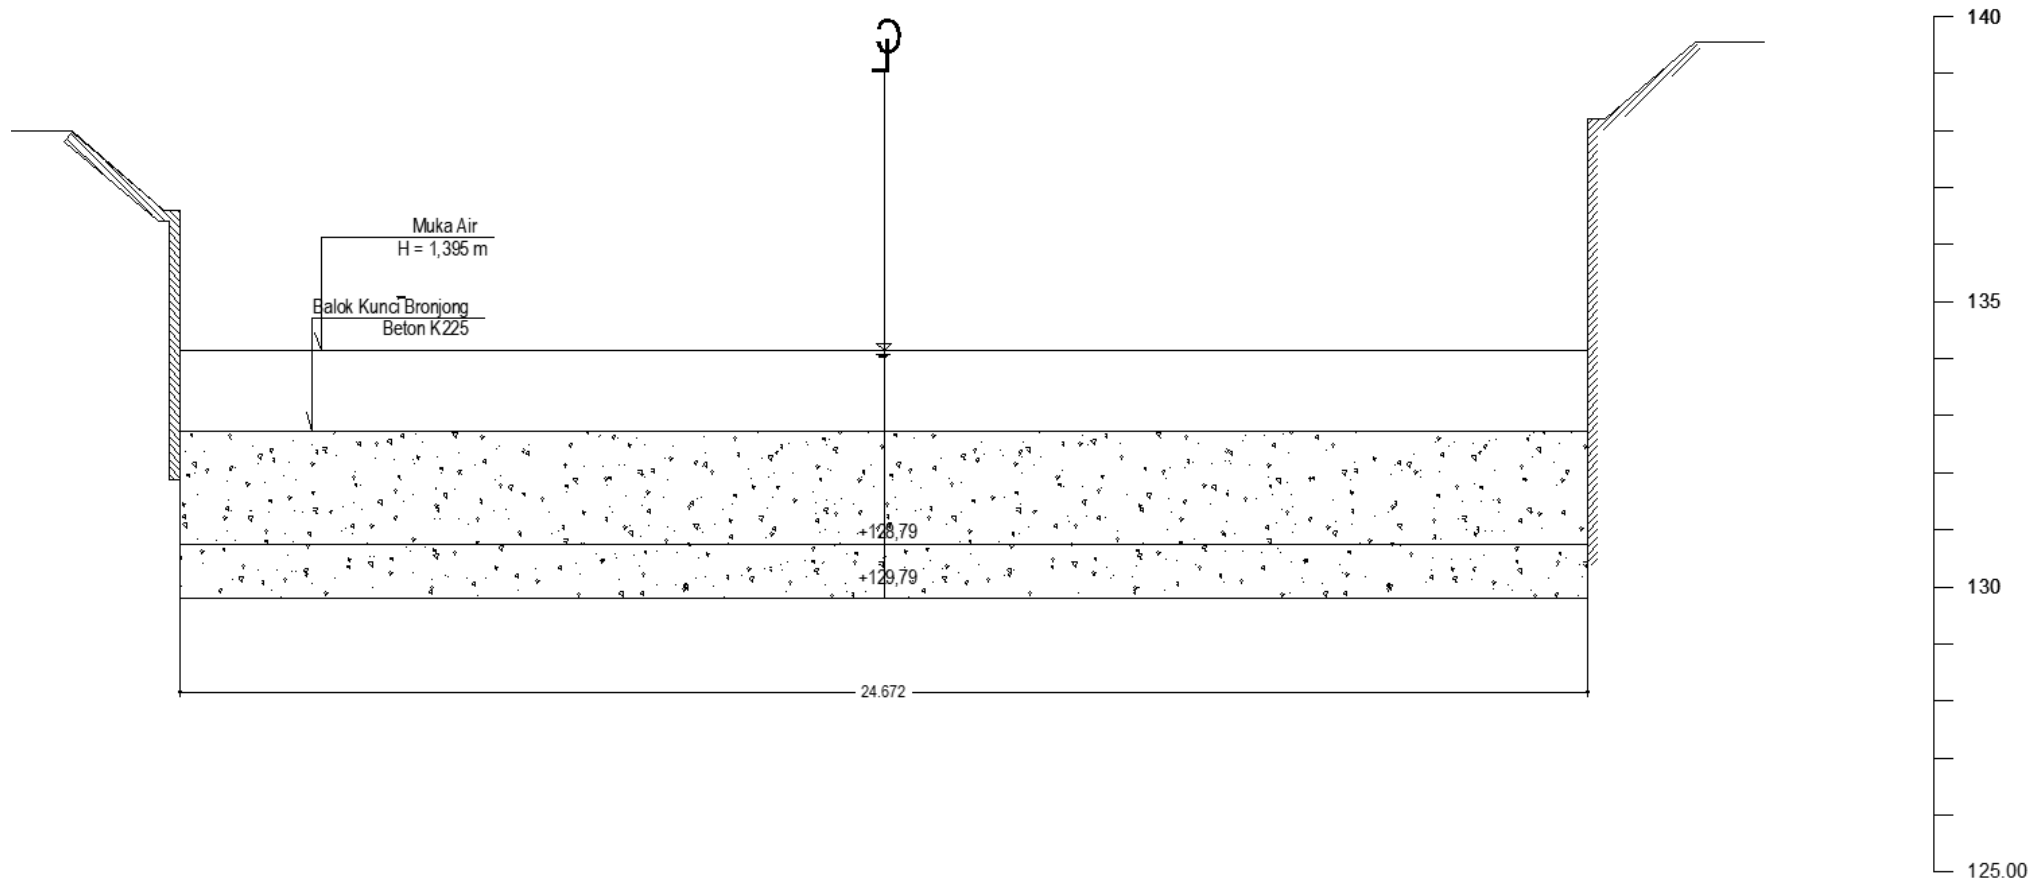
Gambar Rencana Cross Section Tanggul Pembatas (River Diversion) Dan Bangunan Groundsill Yang Telah Selesai Pada Potongan I, Saat Proses Dewatering Berlangsung Progress 75%
